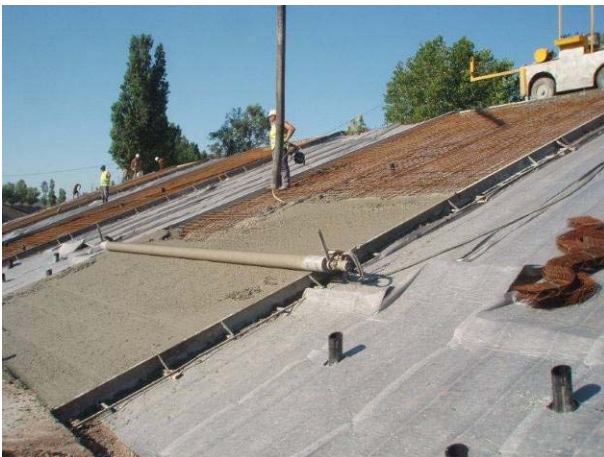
REPARATION DES DALLES DU REYRAN - PHASE DE BETONNAGE APRES FERRAILLAGE
